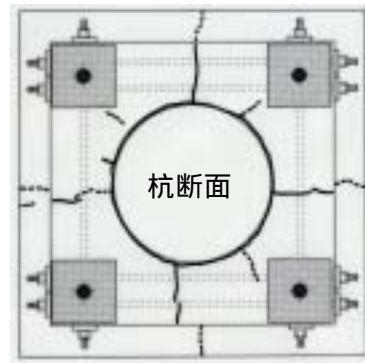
最終ひび割れ状況(試験体 No.21)
